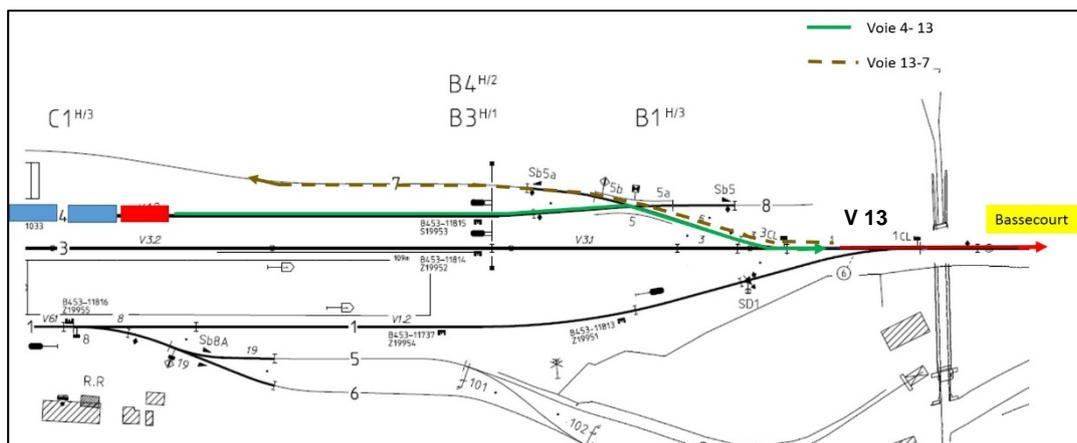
Plan des installations de sécurité de la gare de Glovelier. Vert, mouvement de manœuvre voie 4-13; brun traitillé, mouvement de retour prévu sur voie 7; rouge, trajet en direction de Bassecourt (Source CFF; adjonctions SESE).
